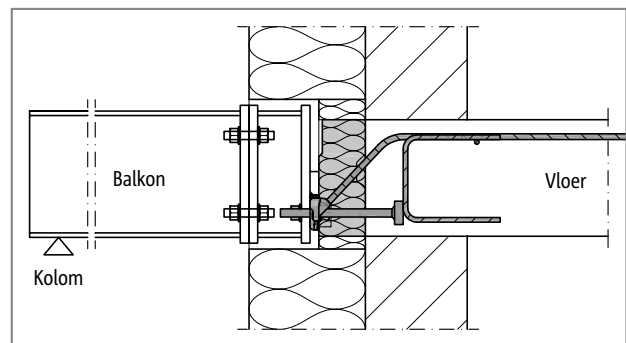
Schöck Isokorf® T type SQ: barrièrevrije overgang door hogere positionering
